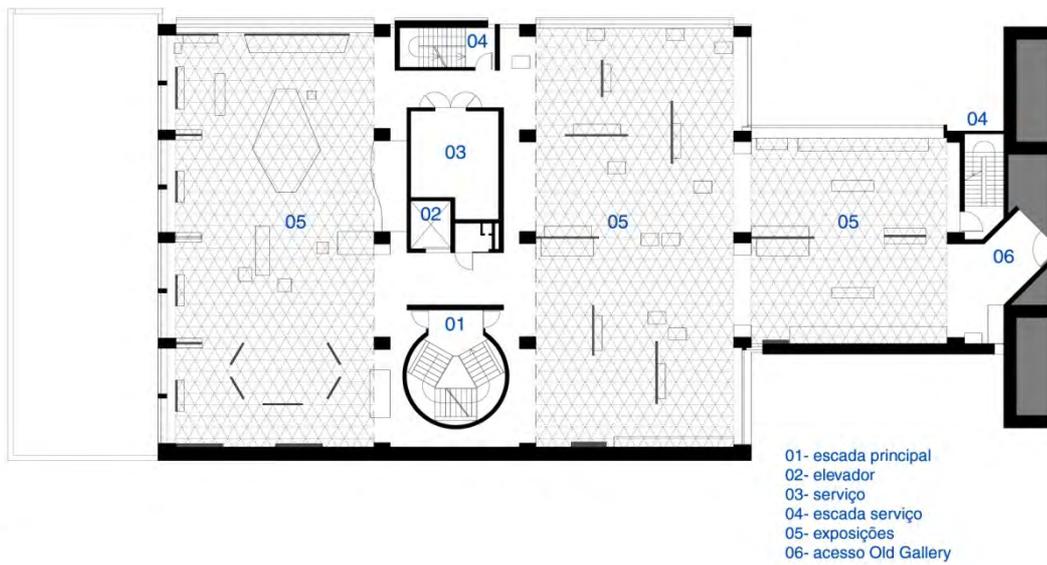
| Planta 2º ao 4º pavimento YUAG [redesenho do autor]
